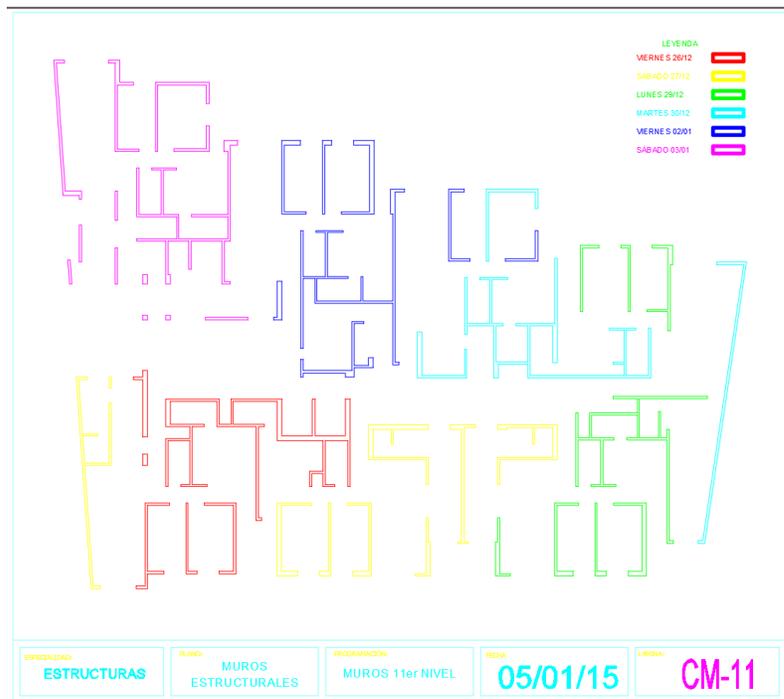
Sectorización de Muros Nivel 11. Fuente: Elaboración Propia
